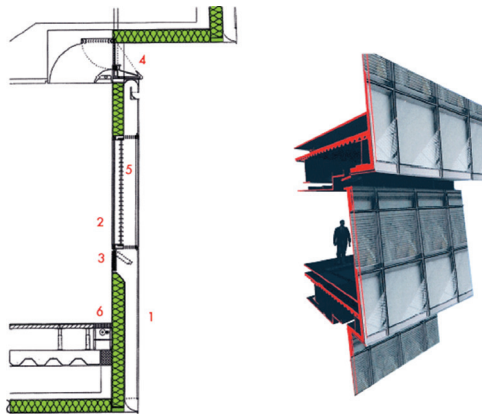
Схема конструкції південного фасаду будівлі мерії Лондону:
